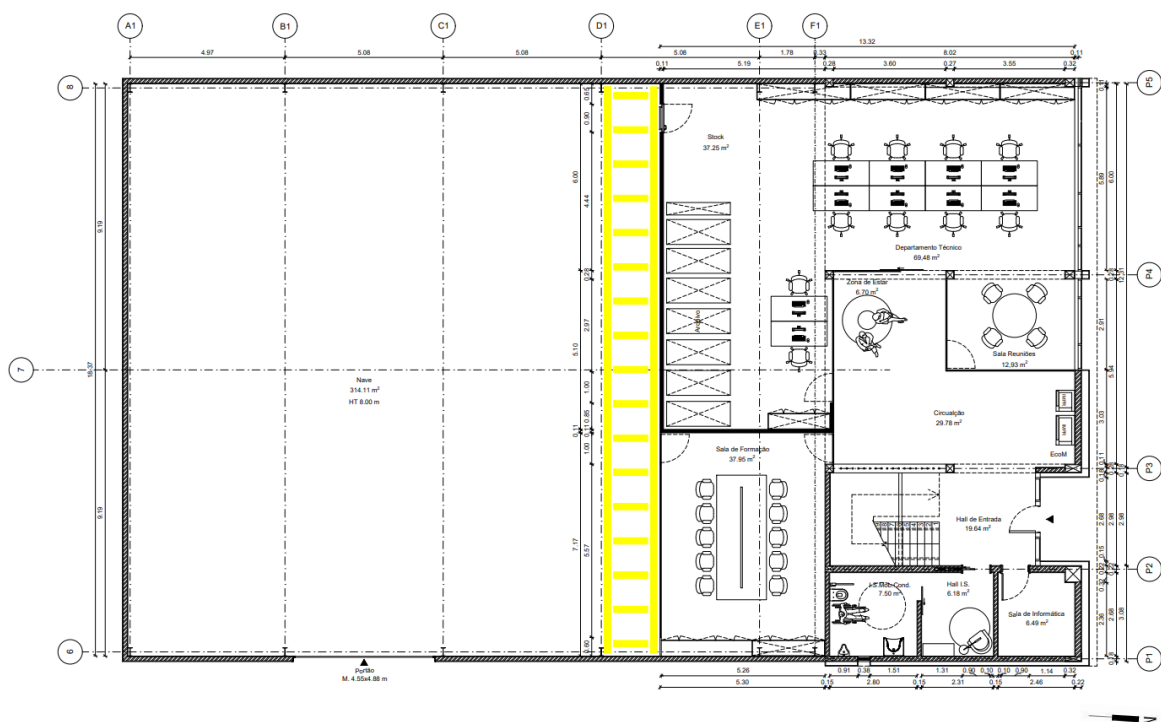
Proposto - Planta piso 0 (EP_R00). Fonte: Garq / Desenvolvimento: Autora.
